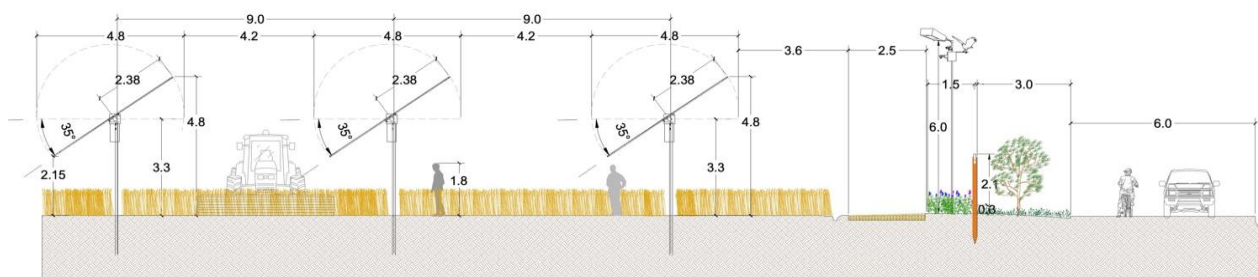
Vista in sezione delle strutture di supporto dei moduli con quotatura
